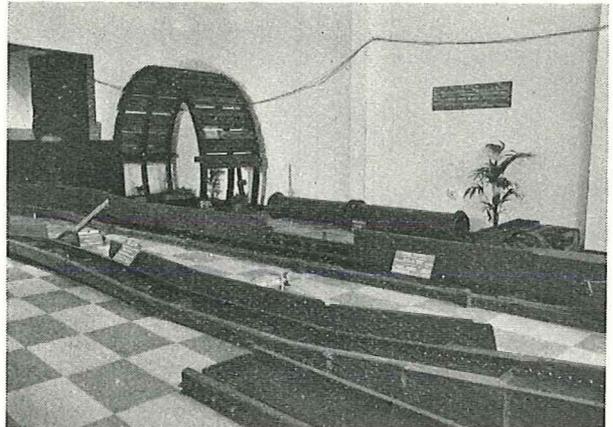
Palplanches métalliques à l'arrière-plan.
